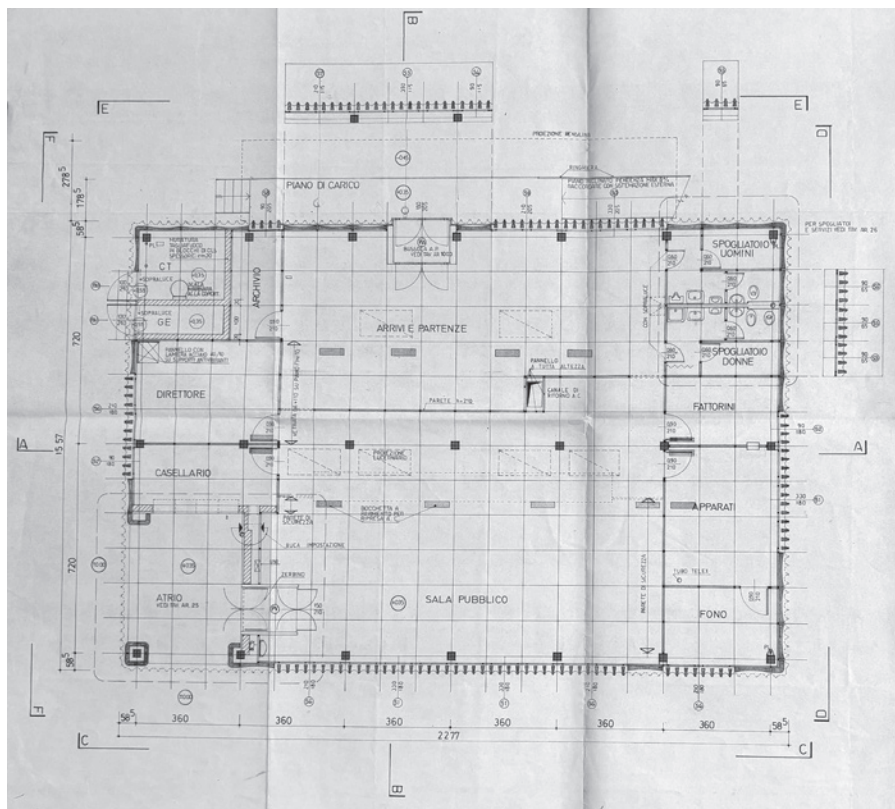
Pianta ufficio D con CTR, con struttura in calcestruzzo armato, progetto IN.CO., 1983 (ASF, b. 147A)
